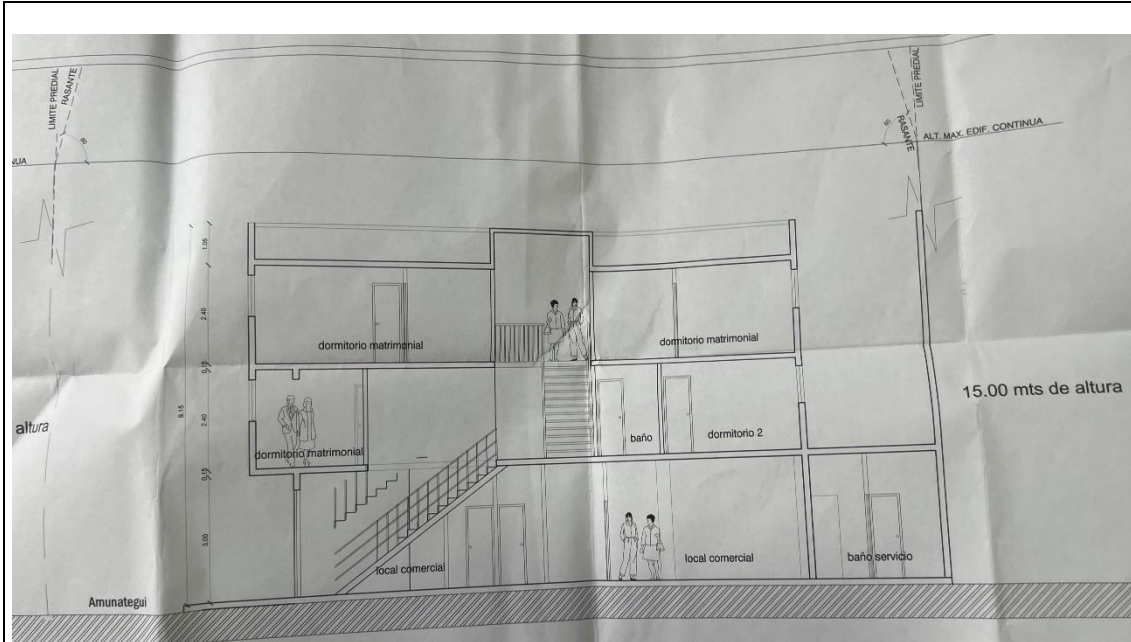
, Corte C-C de la lámina N° 3 del proyecto de arquitectura
